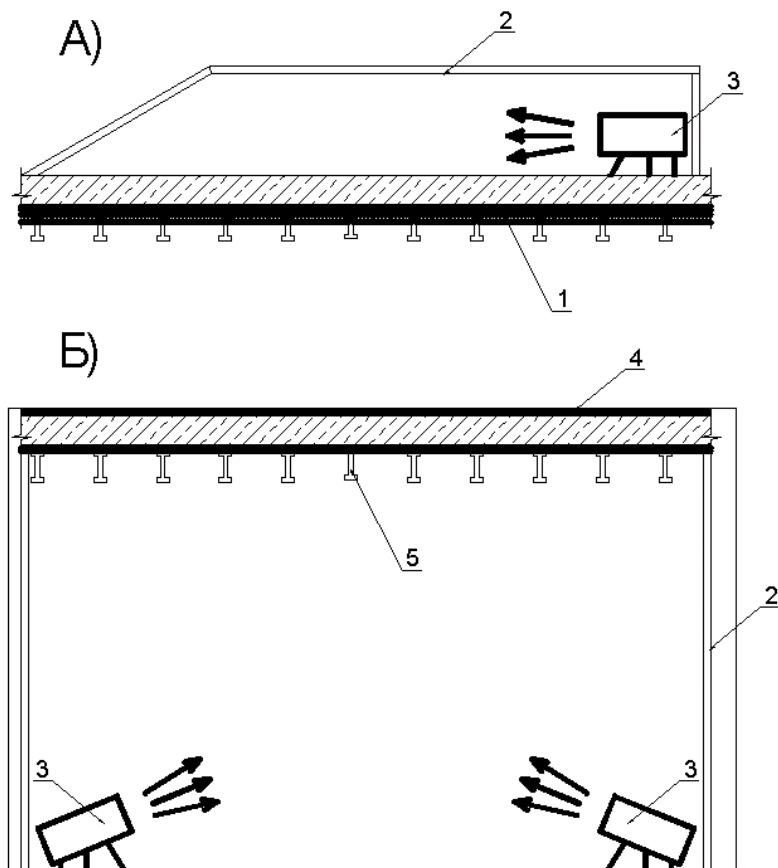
Обогрев конструкции перекрытия. 1 – утеплённая опалубка перекрытия; 2 – конструкция тепляка (закрытая брезентом); 3 – тепловентилятор; 4 - утеплитель плиты
